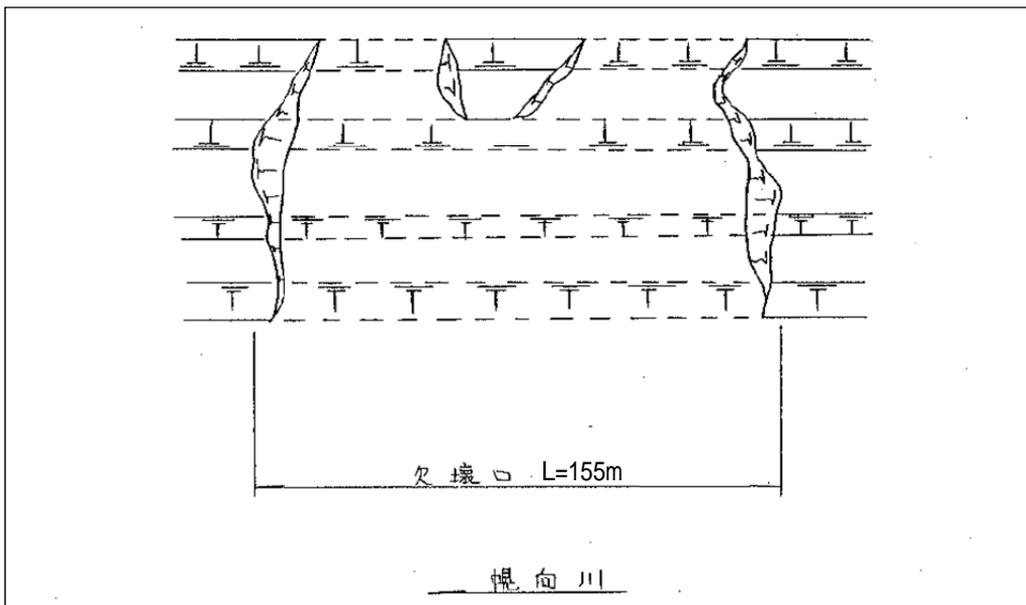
平面図 (⑤幌向川 : 西 1 号橋下流)
